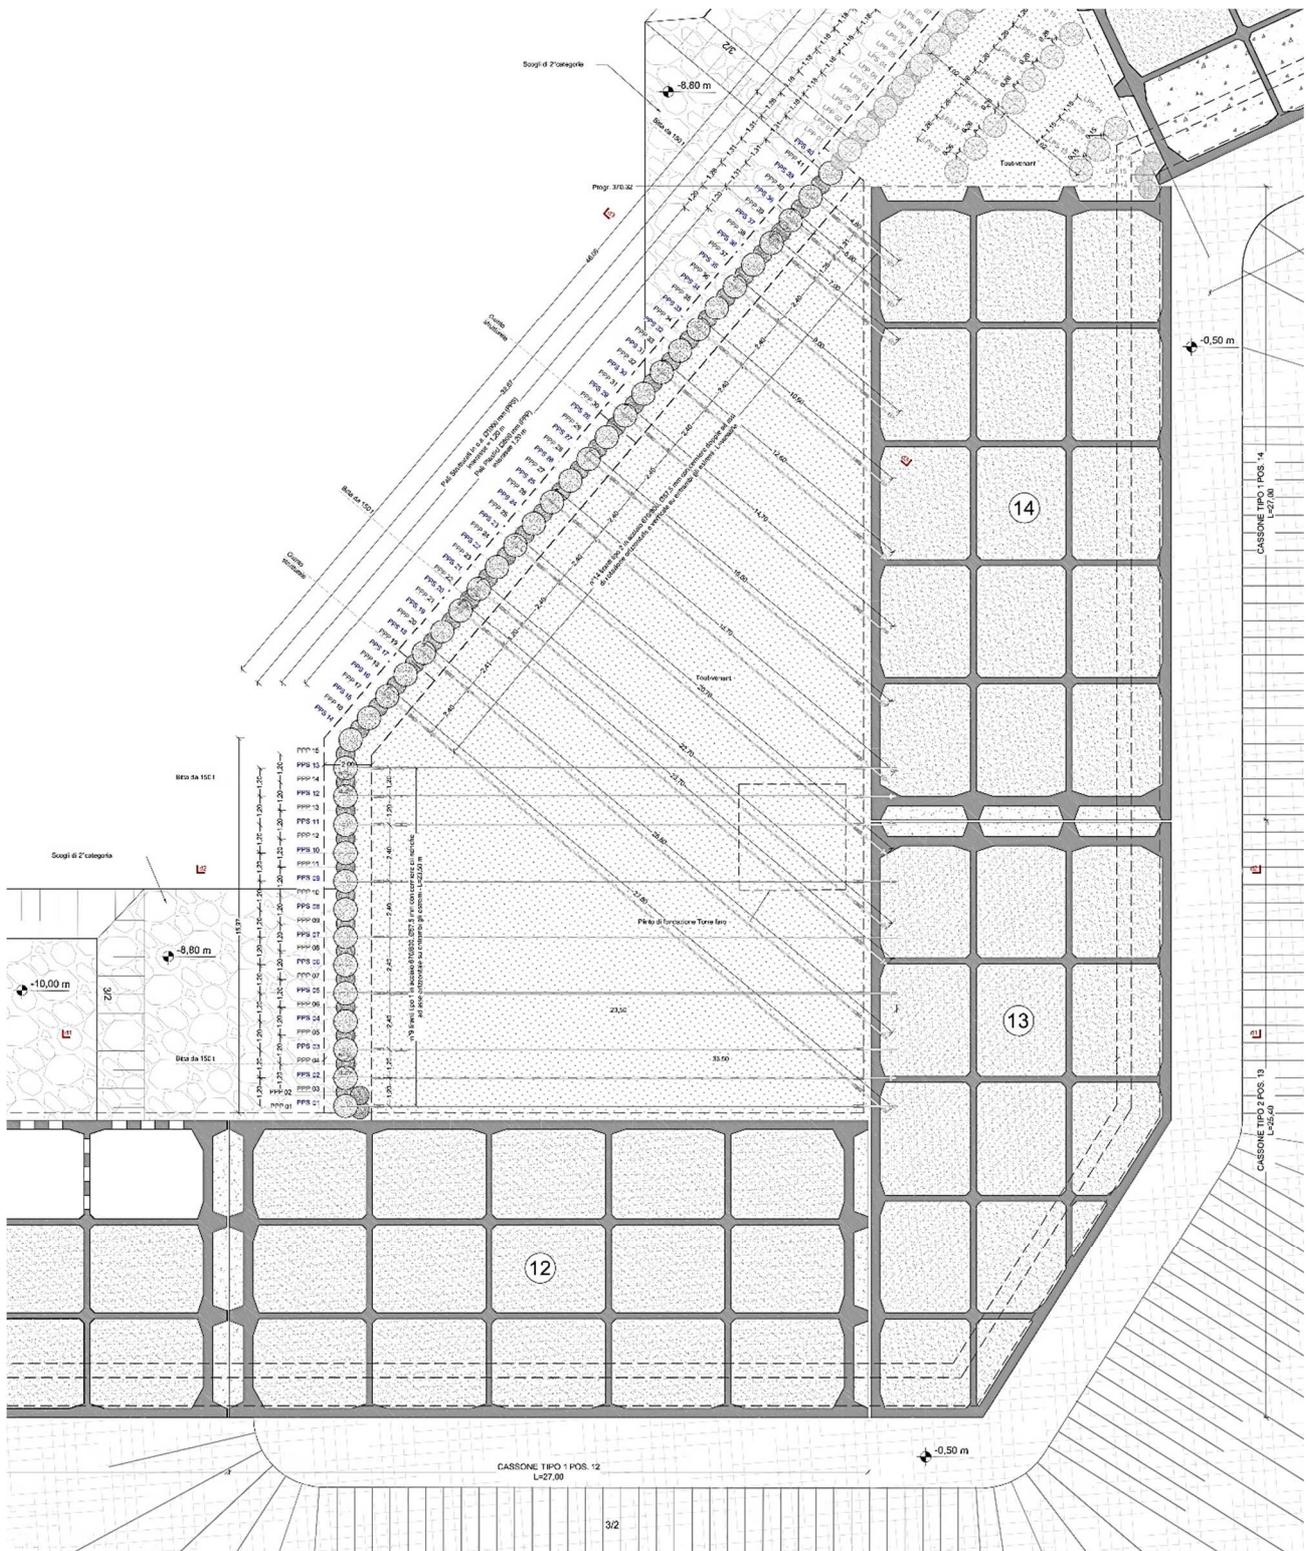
Piazzale in testa alla Diga di Sottoflutto: Planimetria costruttiva
